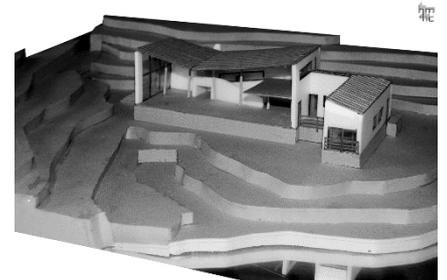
Maqueta con Sección longitudinal de Casa Errázuriz
